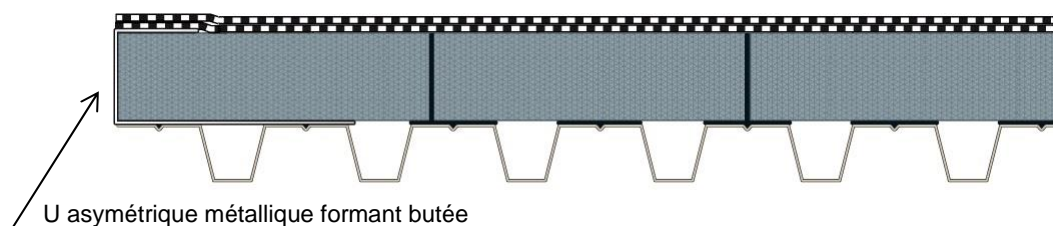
Coupe de principe sur rive sans acrotère, sur élément porteur métallique
